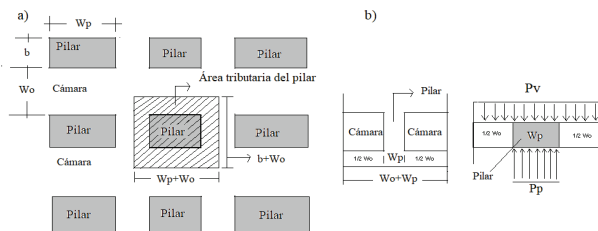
Diagrama de cámaras y pilares con fuerzas en planta y en sección transversal unitaria: a) área tributaria del pilar b) fuerzas en pilar, en sección transversal al rumbo de la veta; las cargas sobre el pilar corresponden con el peso de la columna de roca del área tributaria que lo suprayace hasta superficie. Fuente: [6].
